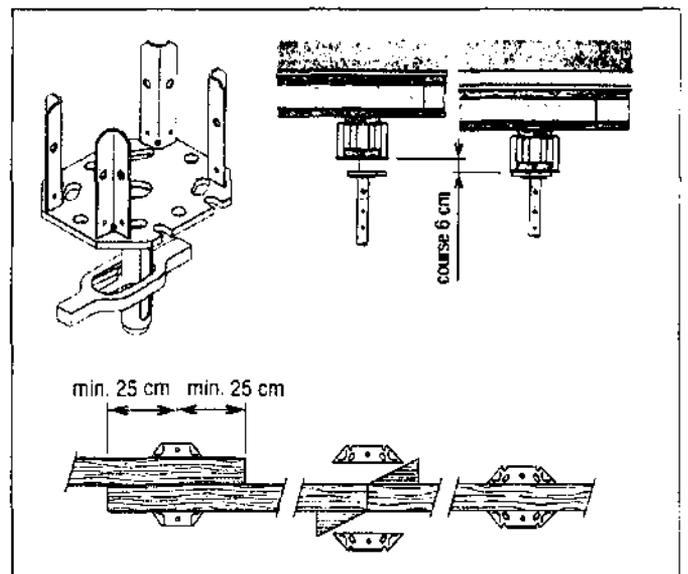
Repos des poutrelles sur une fourche et décintrage (doc. Doka).
